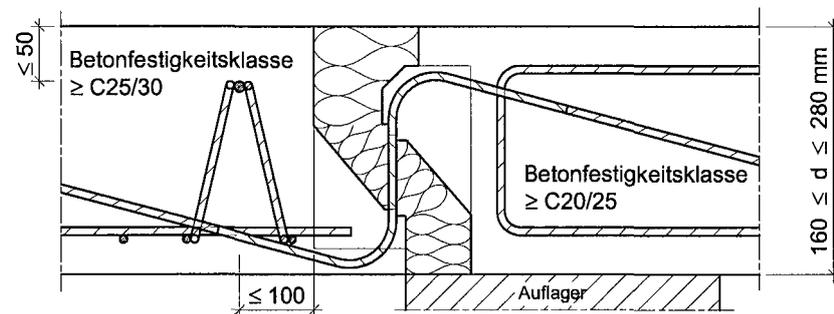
Beispiel Schöck Isokorb Typ V mit Aufhängebewehrung nach Abschn. 3.2.1
